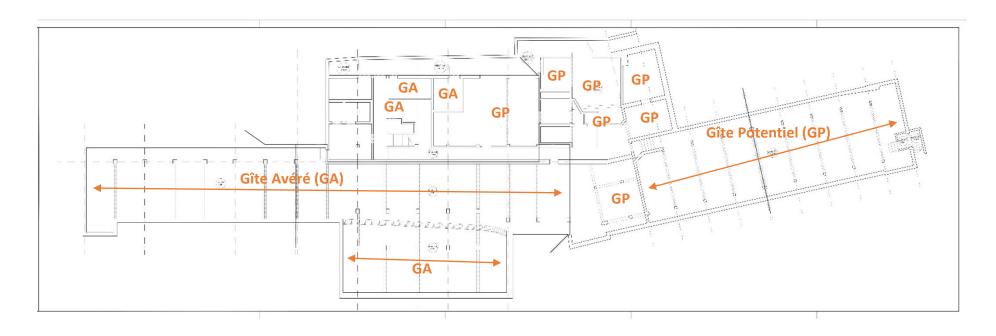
Plans du bâtiment SSR - Rez-de-chaussée
